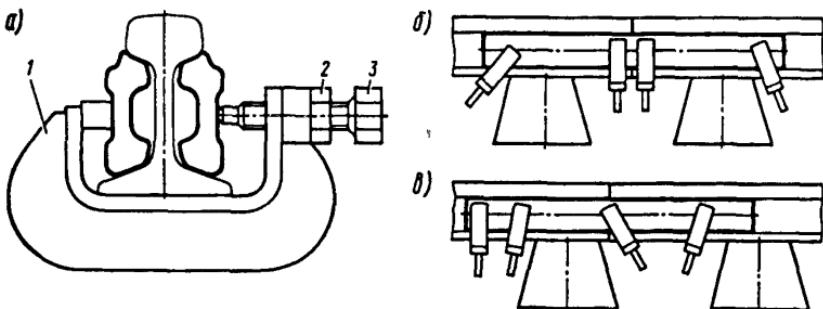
Струбцина для стягивания накладок при изломе рельсовой плети (а) и схемы ее расположения при изломе рельса между шпалами (б) и на шпale (в):
